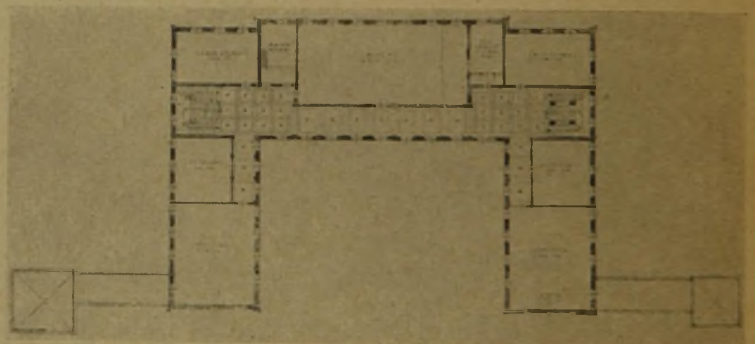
Grundriß. I. Ob.-Geschoß. (1:1500.)
